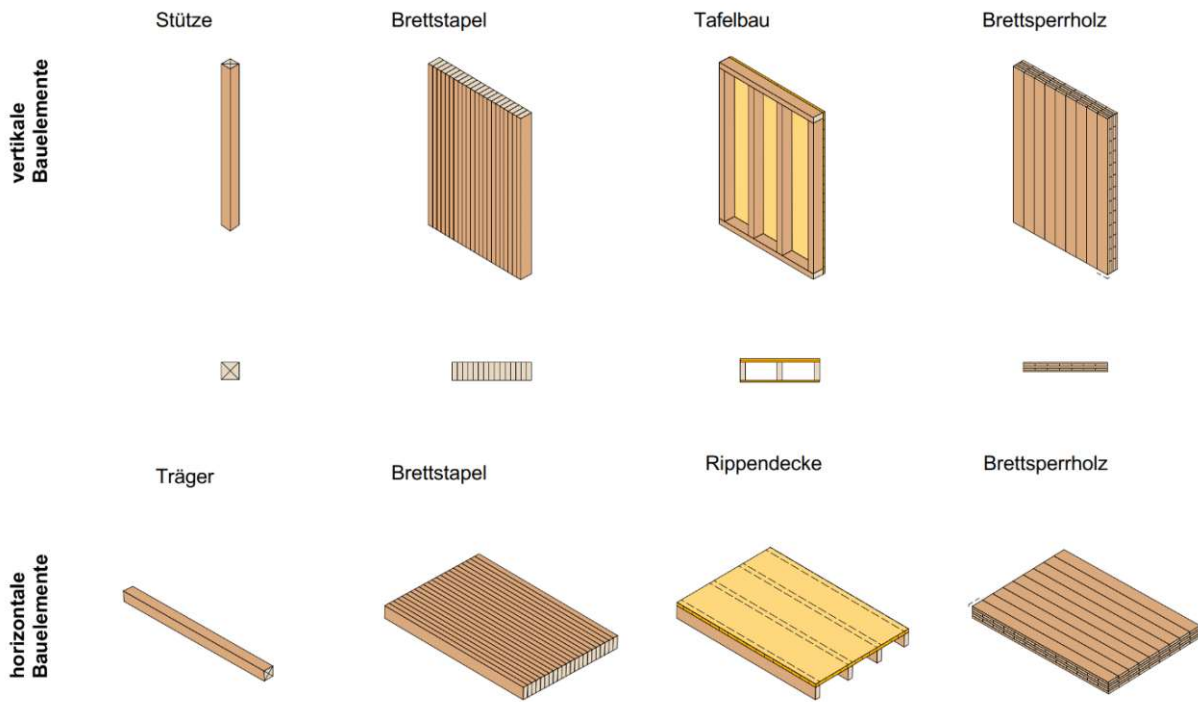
Vertikale und horizontale Bauelemente aus Holz (Eigene Darstellung nach [57])
